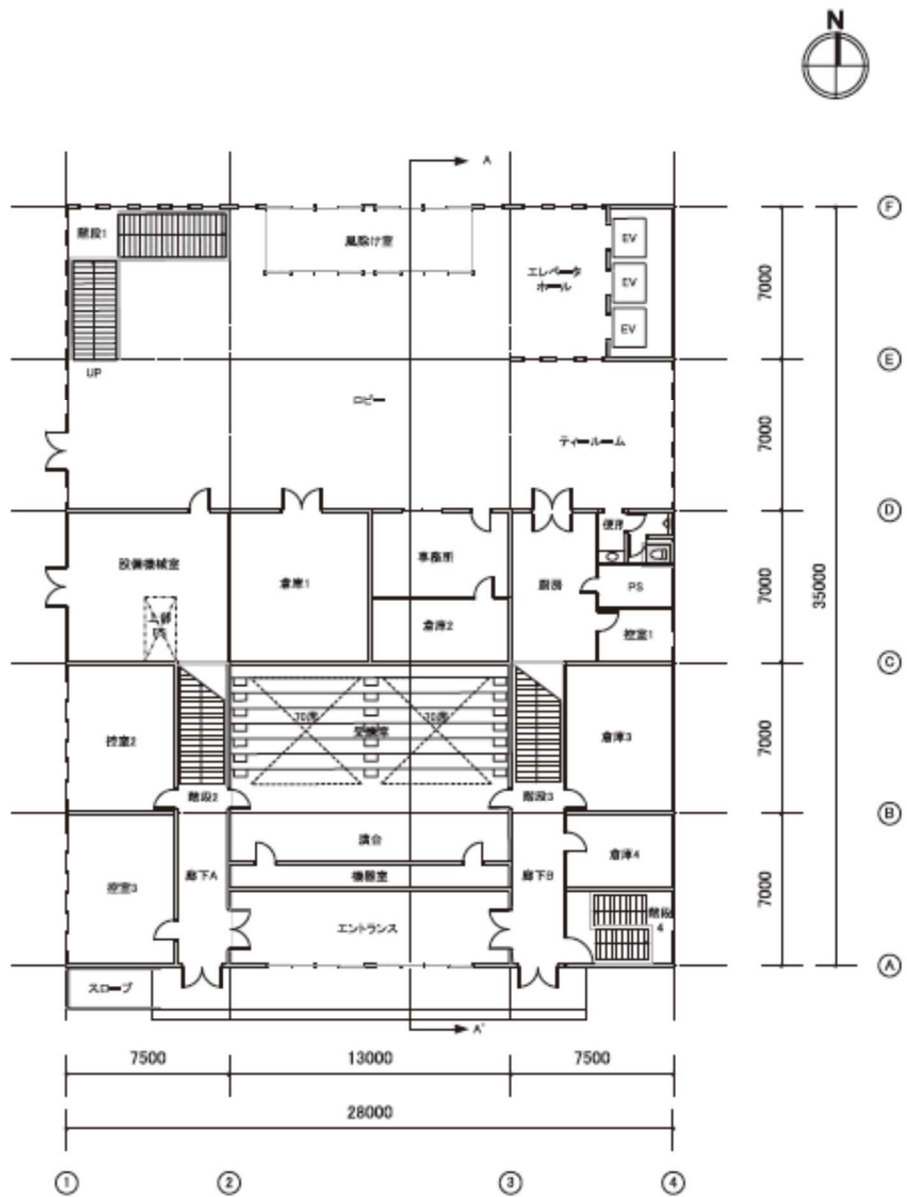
1 モデル建物（大学等、低層棟） 1階平面図
